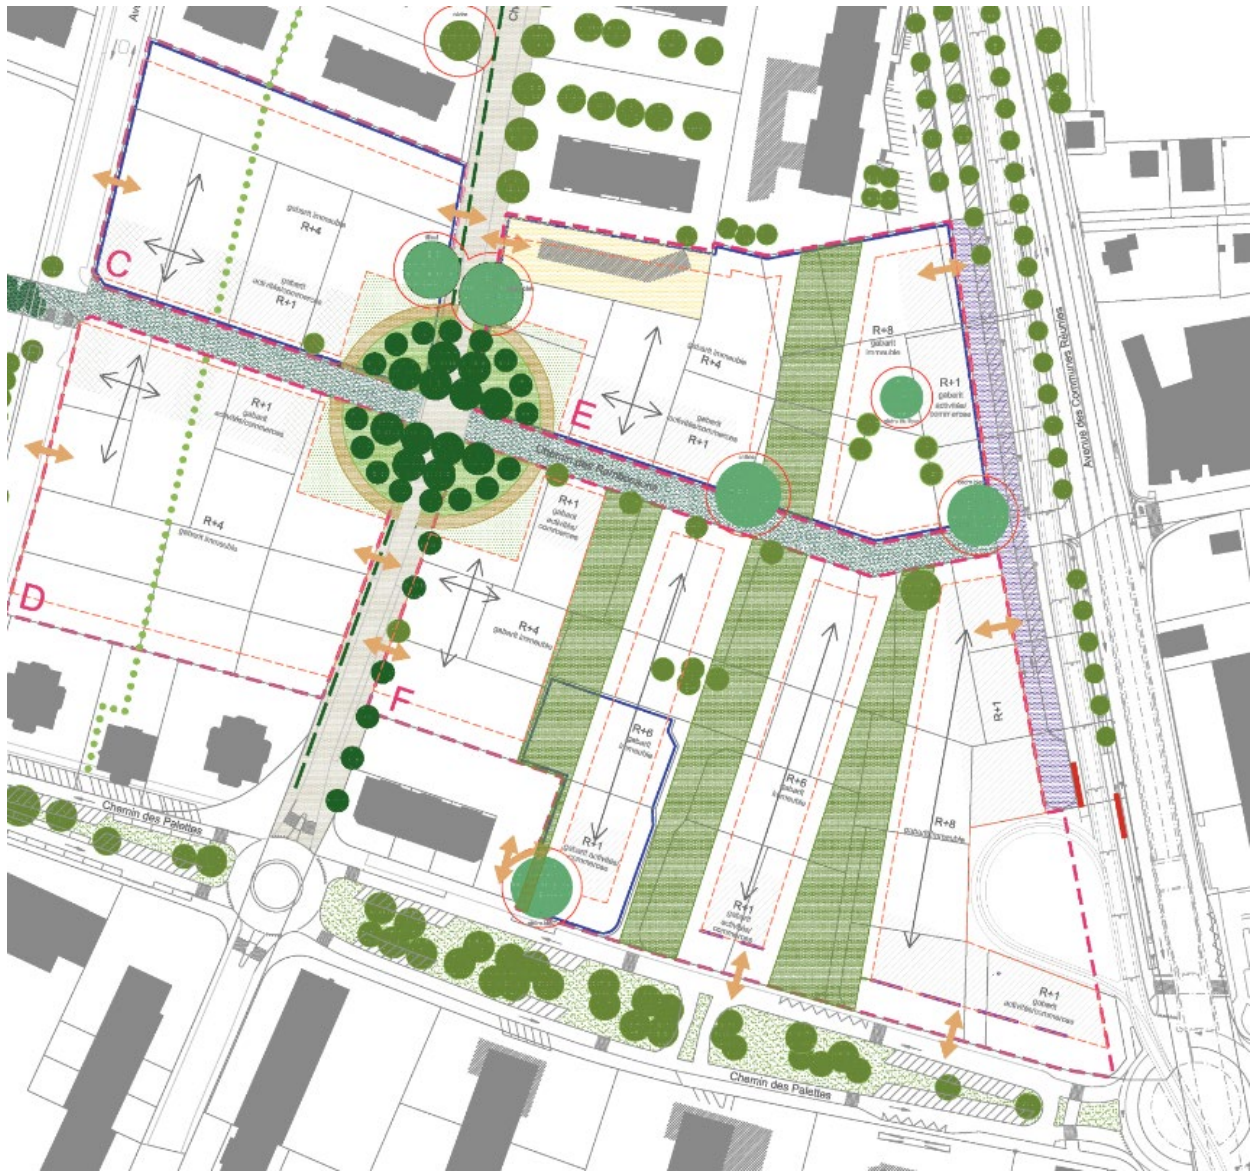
Plan de synthèse du PDQ N° 29889 des Semailles
